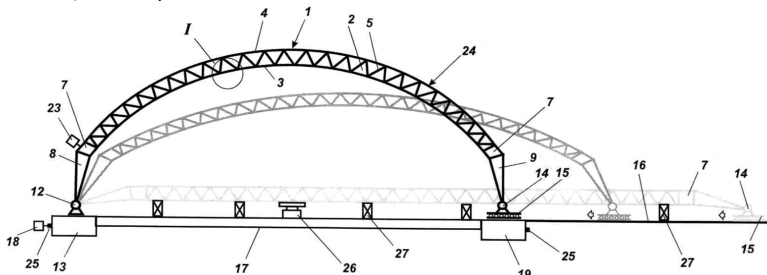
Арка, выполненная в виде фермы, большепролетного покрытия ангара в сборе, момент монтажа [4], где: 1 – фермы покрытия; 2 – секции; 3 – нижний пояс секции; 4 – верхний пояс секции; 5 – раскосы; 7 – несущие опорные узлы; 8 и 9 – колонны; 12 – шарнир; 13 – проектный фундамент; 14 – шарнир; 15 – подвижная опора-тележка; 16 – направляющая скользящая опора; 17 – несущие канаты; 18 – лебедка; 19 – проектный фундамент; 23 – лебедка; 24 – элементы верхнего пояса; 25 – несущие опорные узлы; 26 – подъемные механизмы; 27 – временные подставки.
